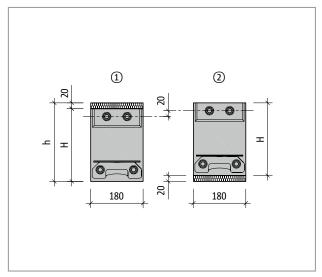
Schöck Isokorb® T tipo SK: Esquinero externo
